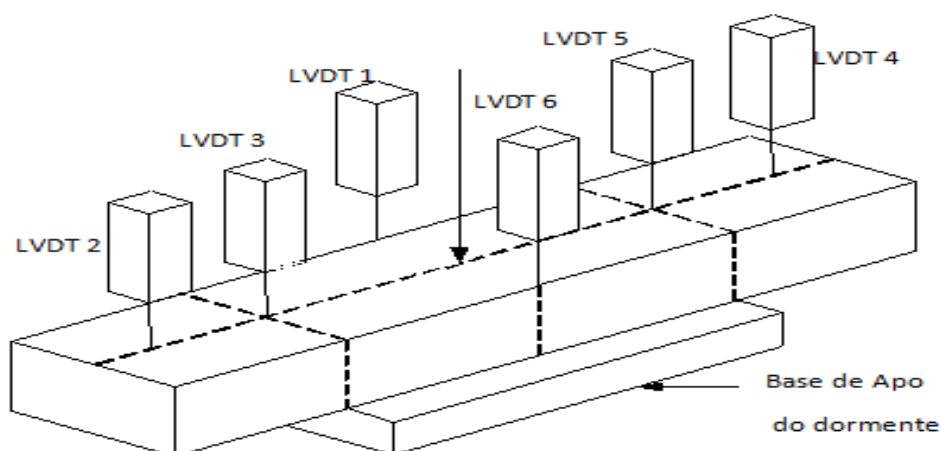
Detalhes da montagem e localização dos LVDTs no ensaio de carga estática.
